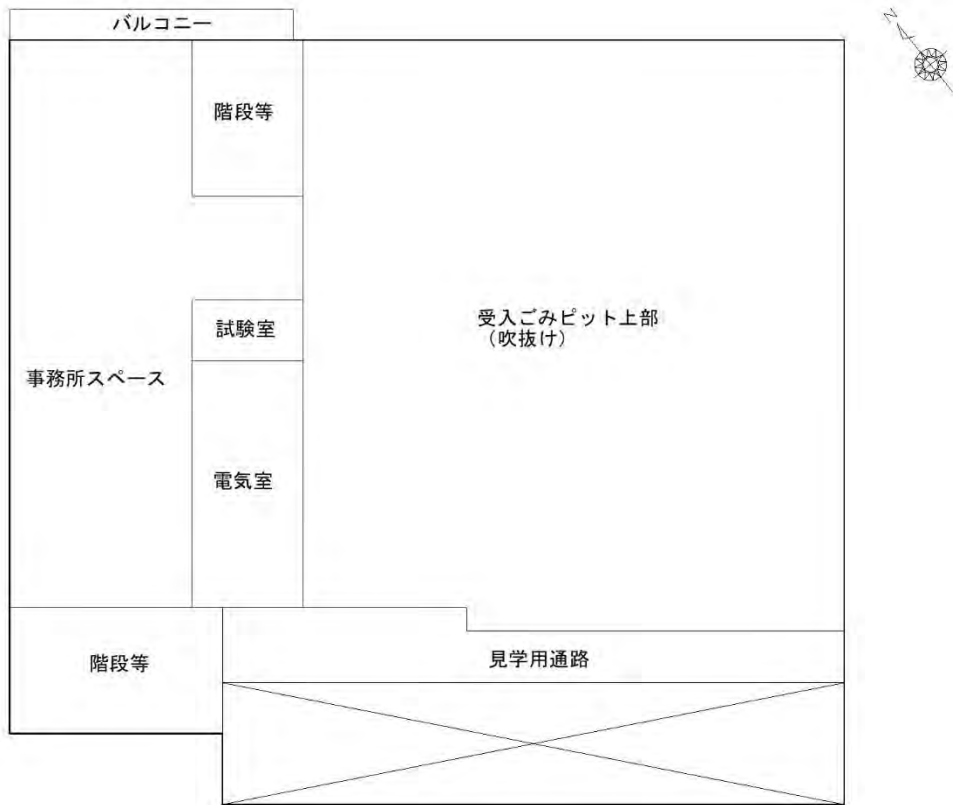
(5) 廃棄物受入棟平面図 (4 階)
